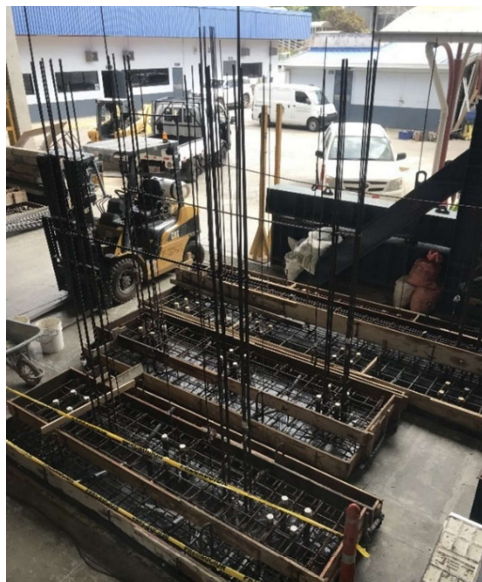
Encofrado y colocación de varillas verticales de paño de mampostería y columnas.
